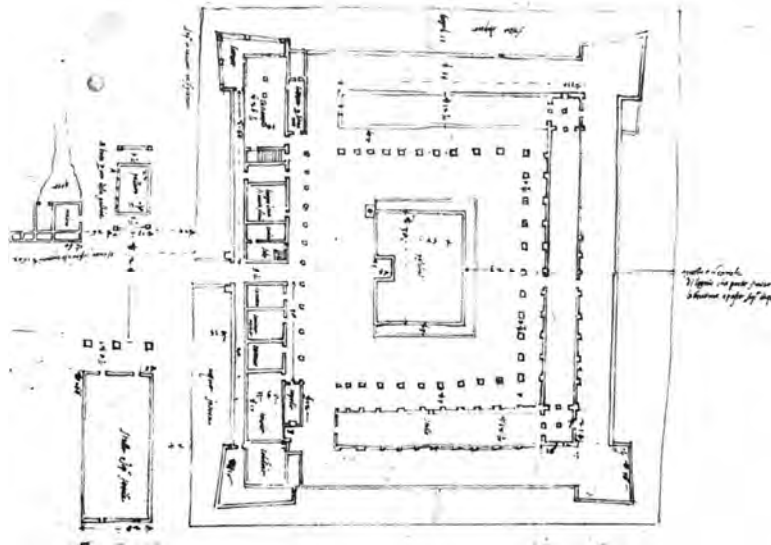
Planimetria della Cascina (Giovannantonio Dosio, 1500 ca)
